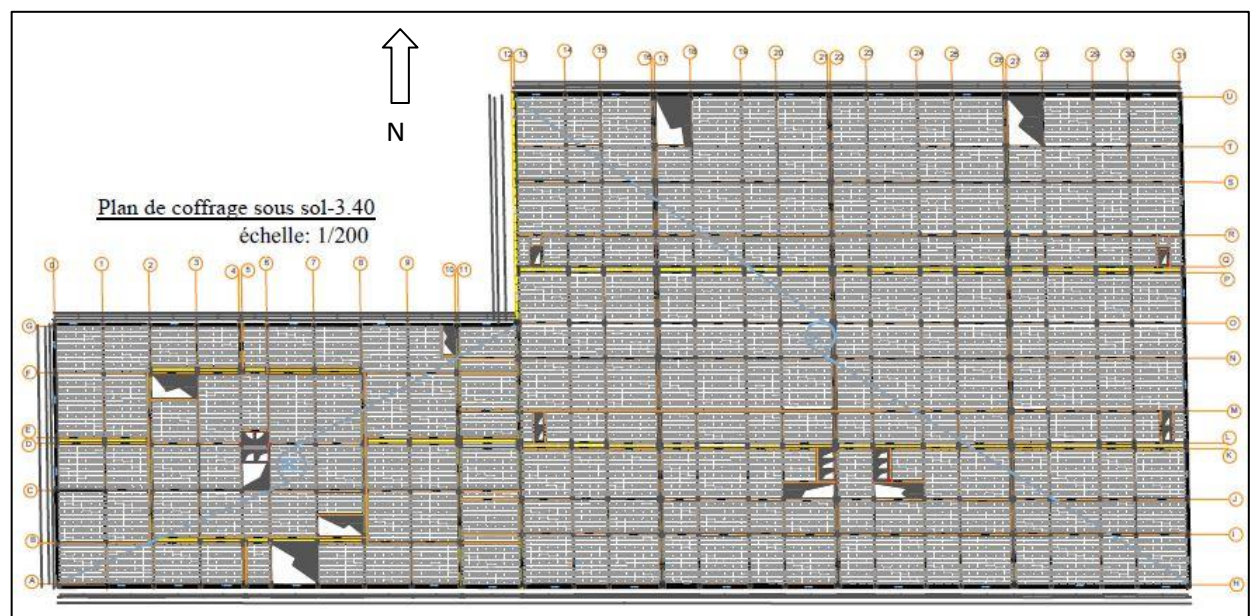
Plan de coffrage -3.40/Source : Traiter par l'auteur.
